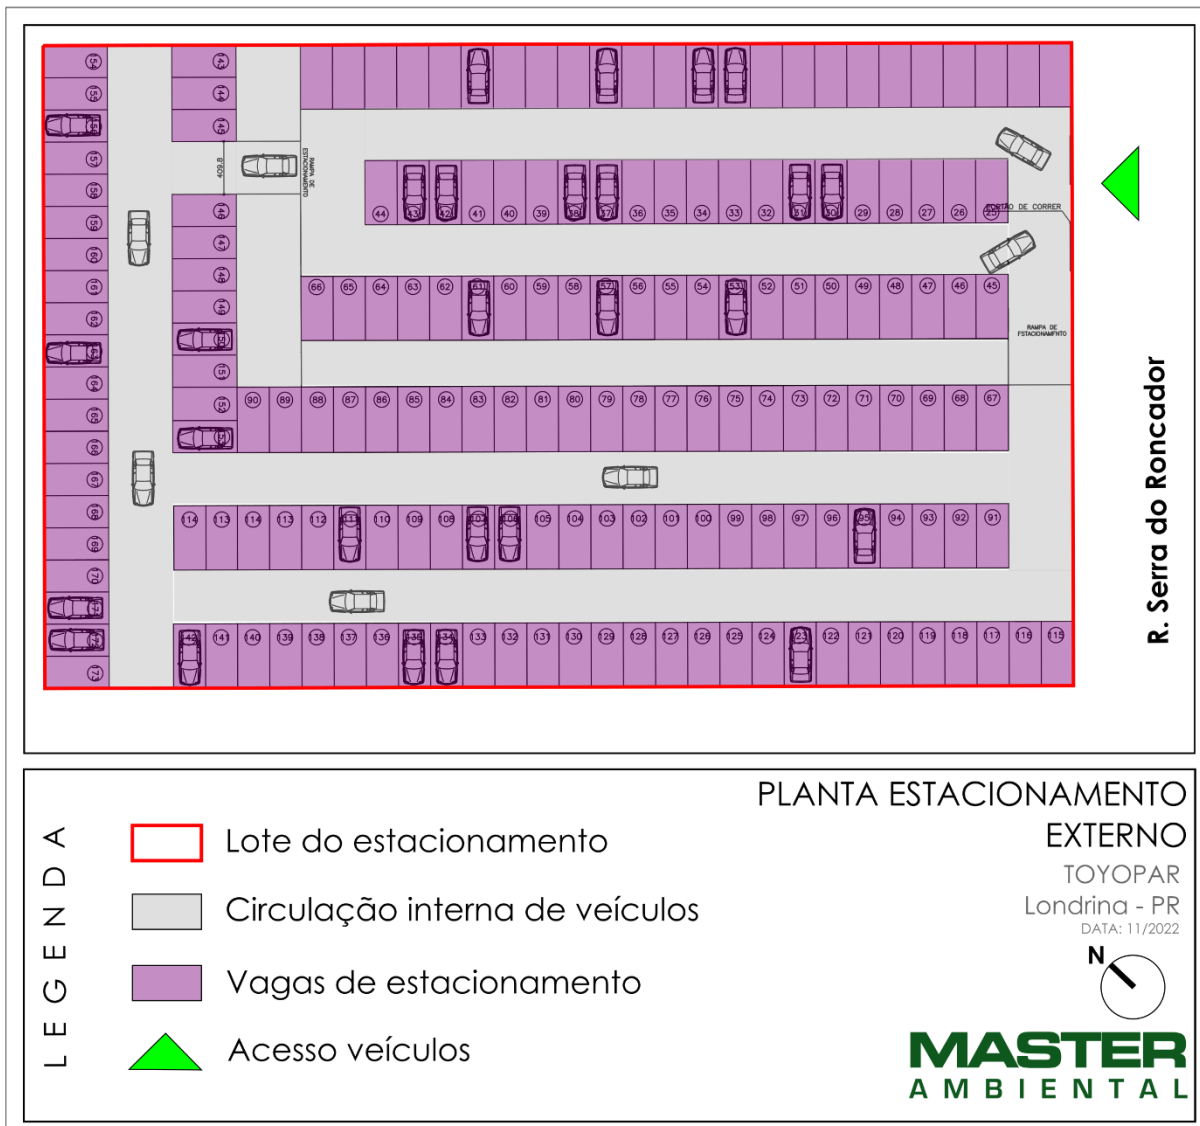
Plantas do empreendimento. Fonte: Projeto As-Built. Adaptado por Master Ambiental.
